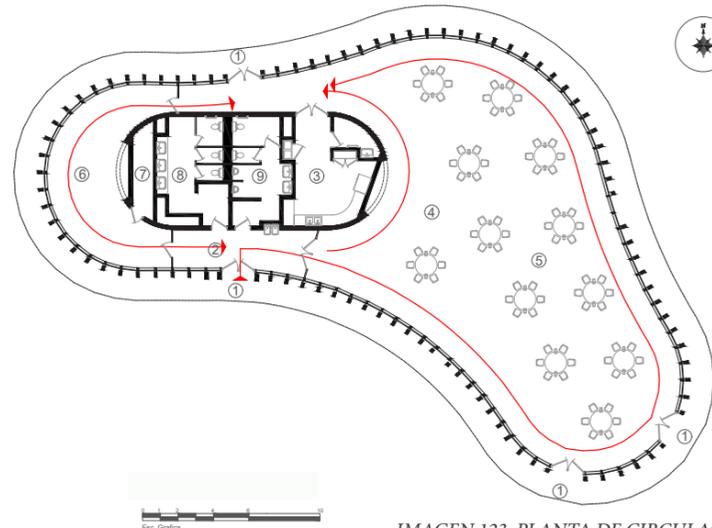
PLANTA DE CIRCULACIÓN
